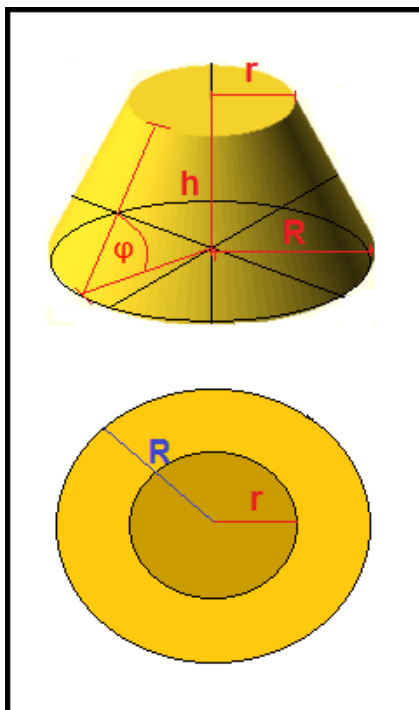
Perfil y vista en planta de una pila de material (stock pile).
